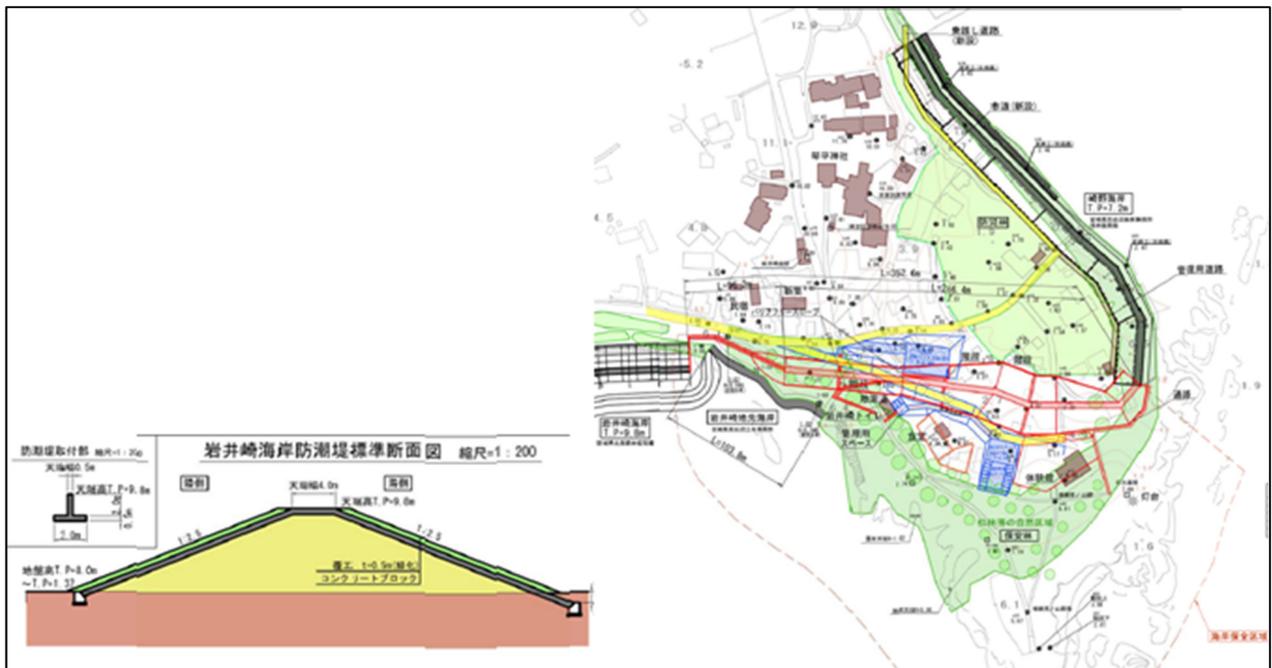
復旧計画平面図及び標準断面図【岩井崎海岸】
